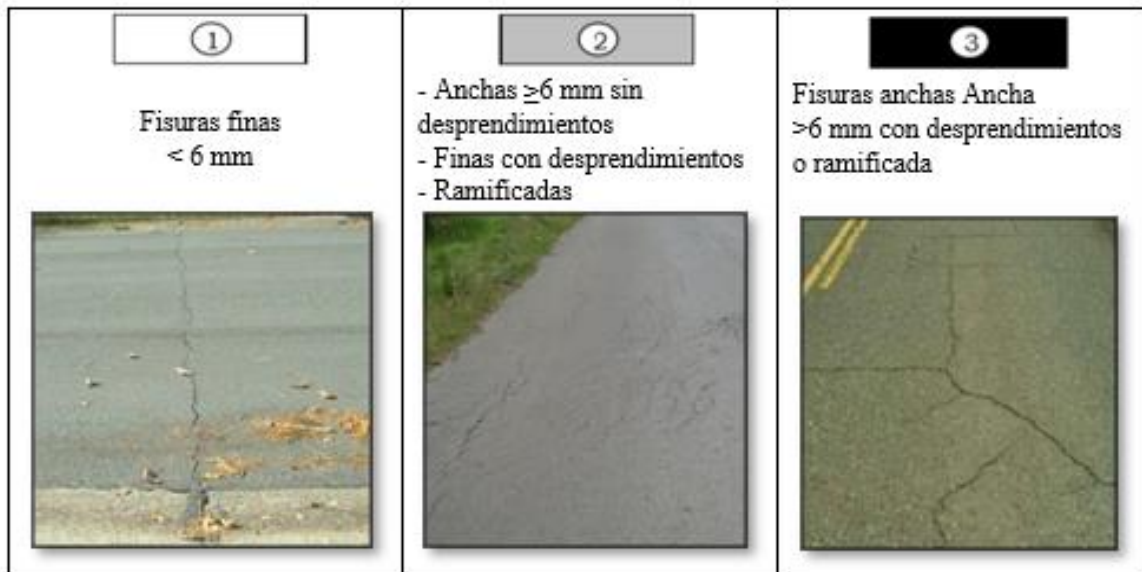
8. Niveles de gravedad fisura longitudinal y transversal de junta de construcción
